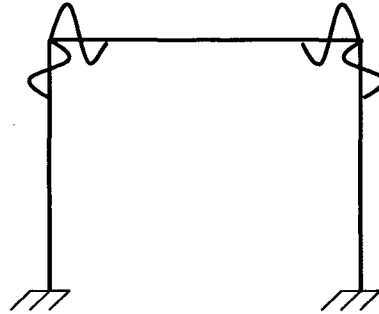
Modelagem para “molas” aplicadas na viga e pilar de um pórtico plano.
